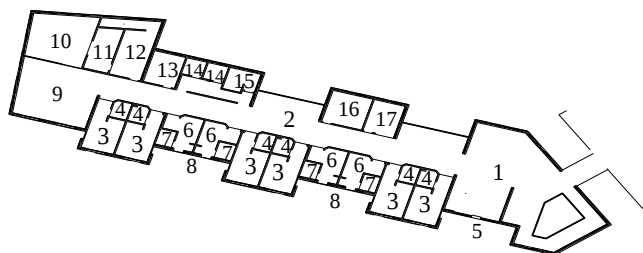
| Planta esquemática do Piso 1 - Bloco de Internamento.
